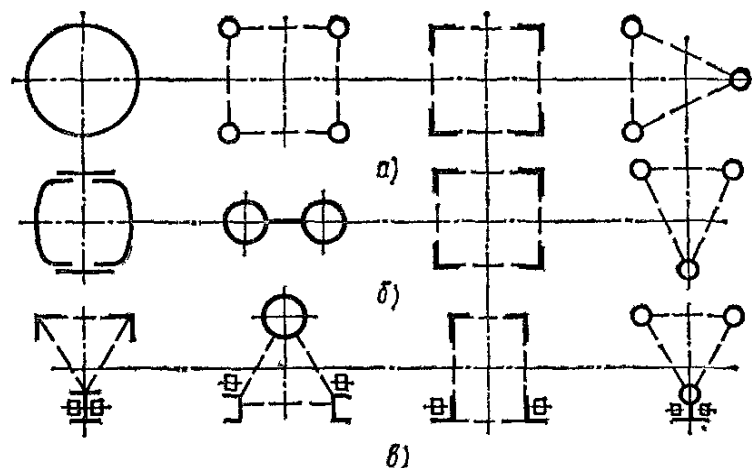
Поперечные сечения металлоконструкций башен и стрел:
